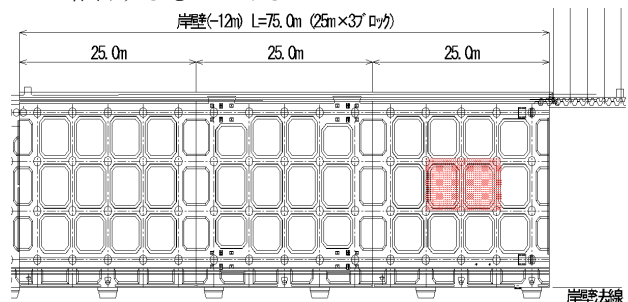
リプレイサブル床版施工位置図 (赤色箇所)
